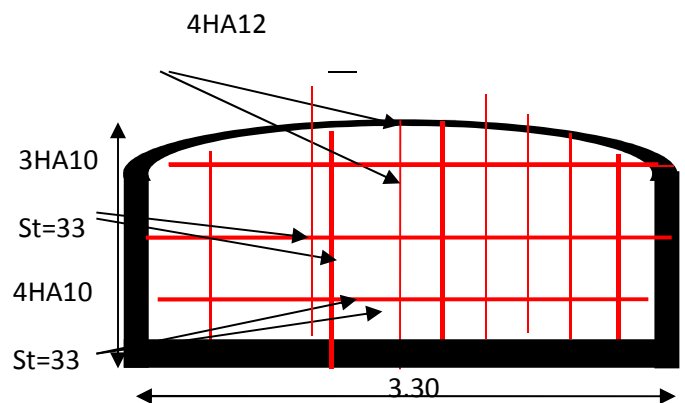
Schéma ferrailage de dalle sur 3 appuis (Balcon)
